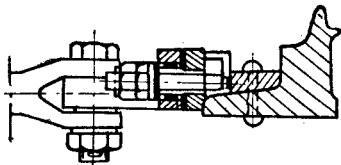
Современная конструкция крепления стрелочной тяги к подошве остряка низкого несимметричного профиля (в стрелке из рельсов Р50)
